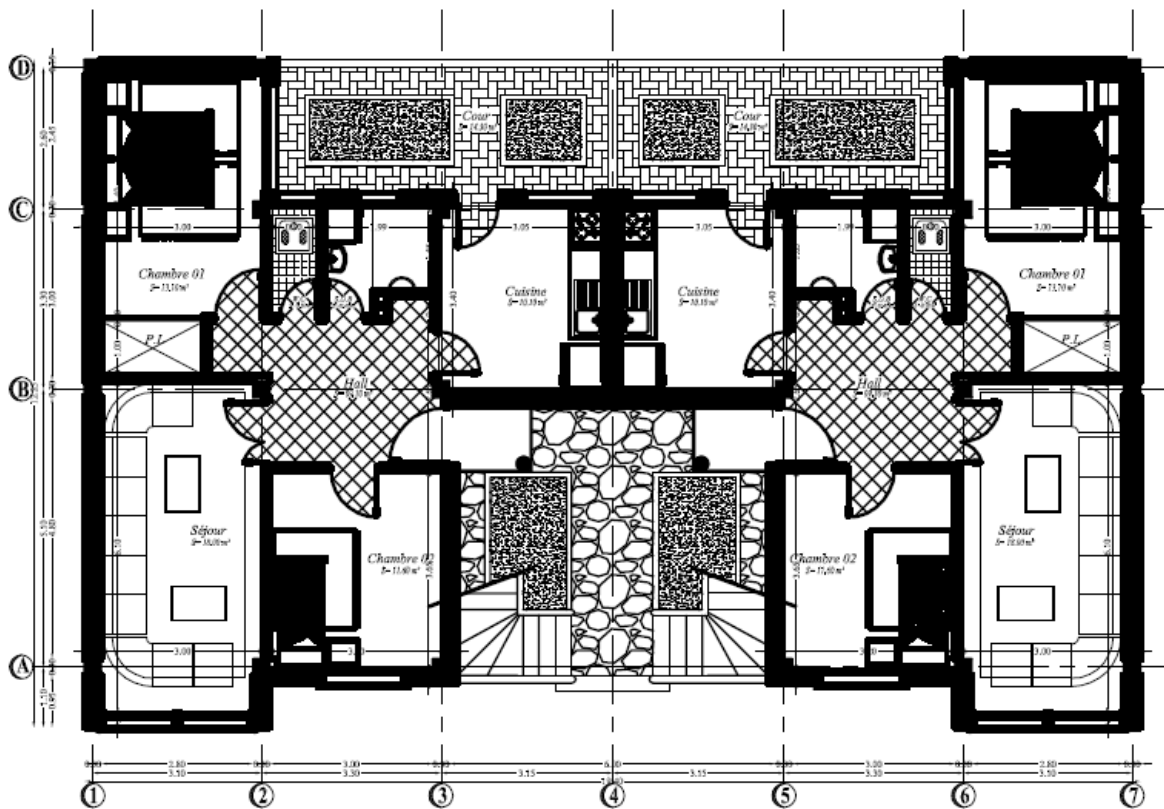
plan du rez-de-chaussée Mostaganem
